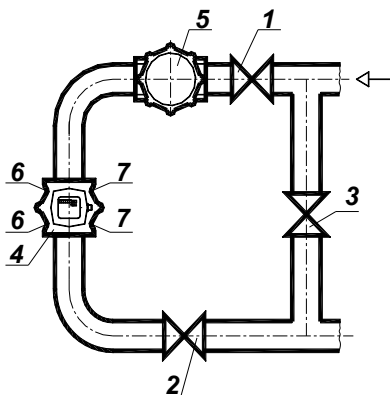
Схема монтажа счетчика (с байпасом) на вертикальном газопроводе
